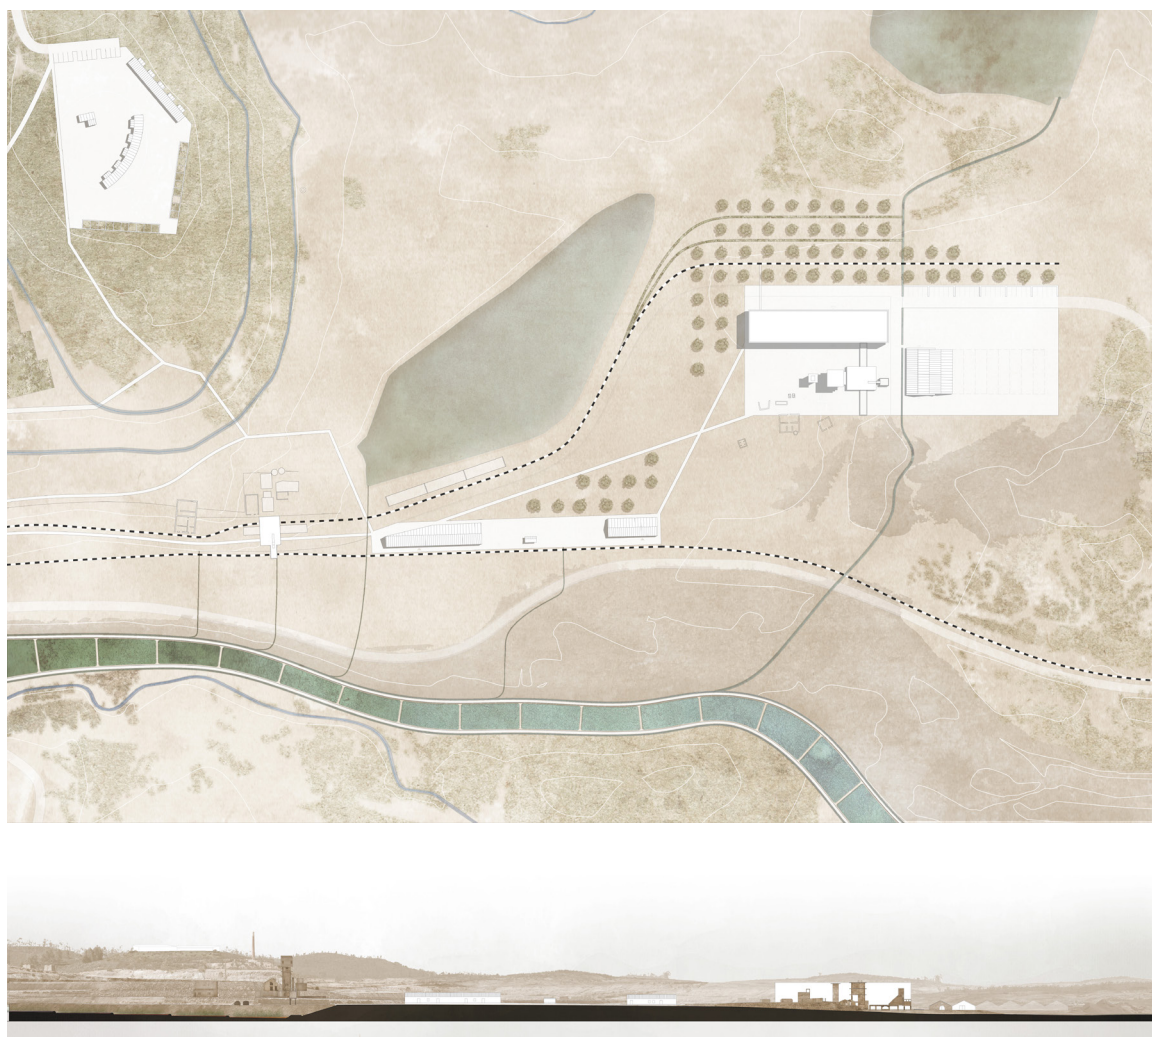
Achada do Gamo: Planta de Implantação do núcleo científico; Perfil-alçado longitudinal do conjunto.
